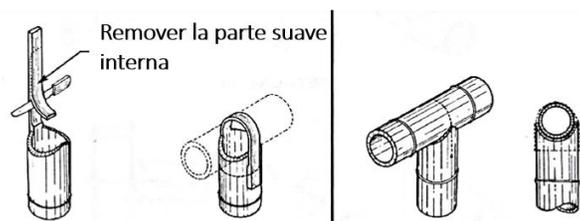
Soporte con corte boca de pescado y amarre por sección de corte de la guadua
